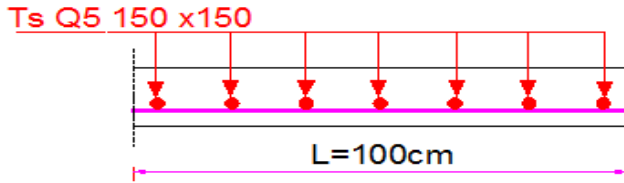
Schéma de ferrailage de la dalle de compression.
